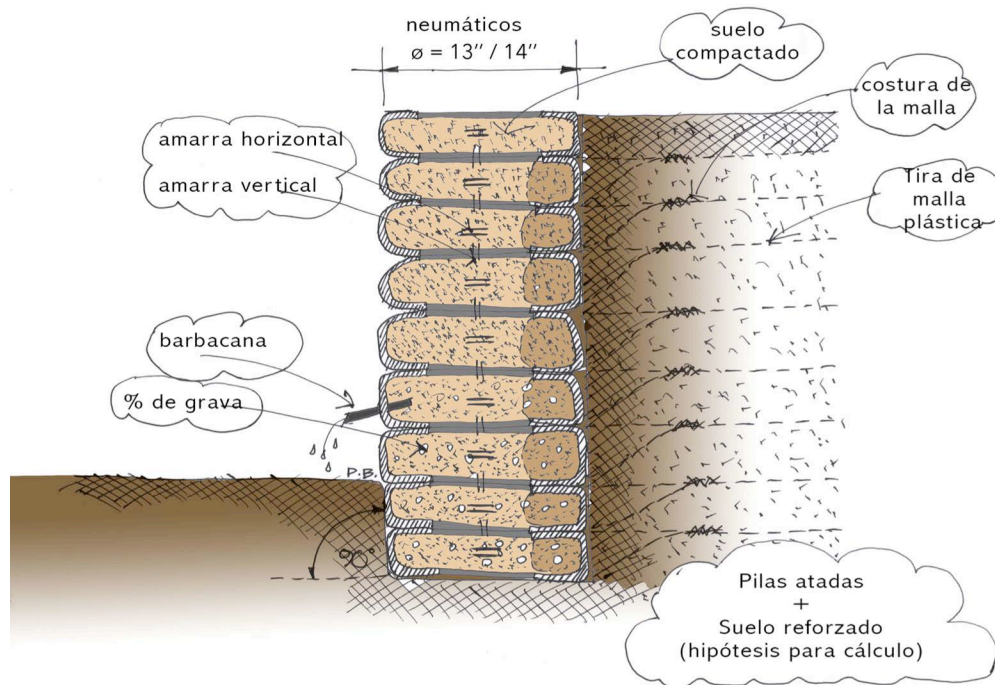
Sección explicativa: características constructivas de un muro de contención (Dibujo: Pablo Barros L.)
